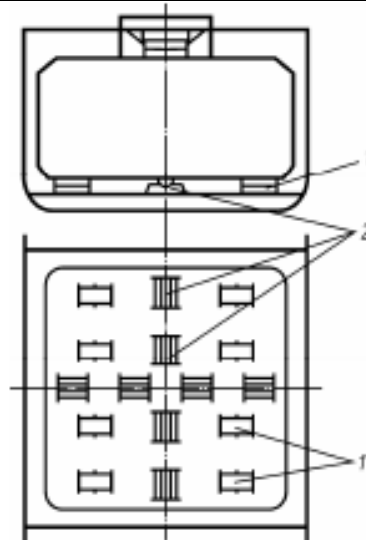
Опори у верхній частині призматичного вантажного танка
